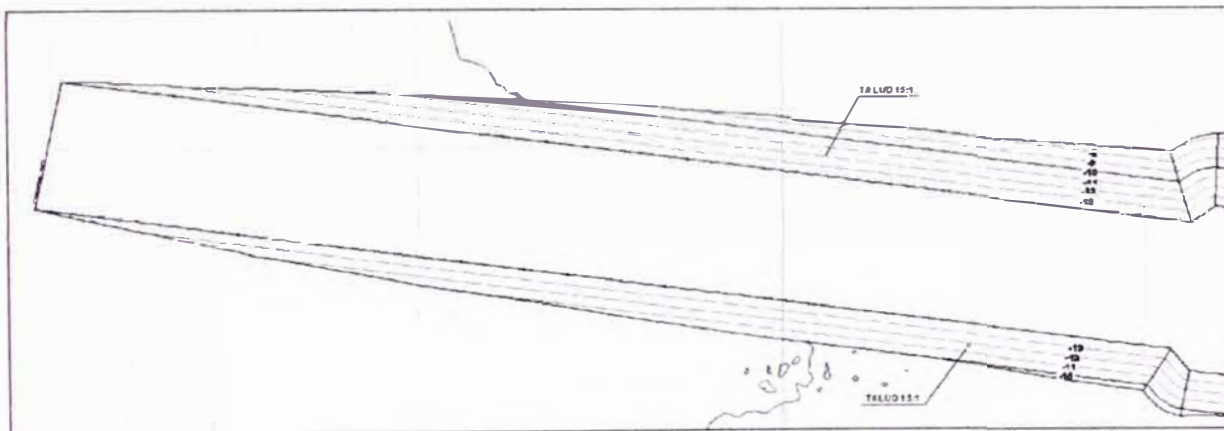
Planta de dragado Fase 1B – Canal de ingreso
